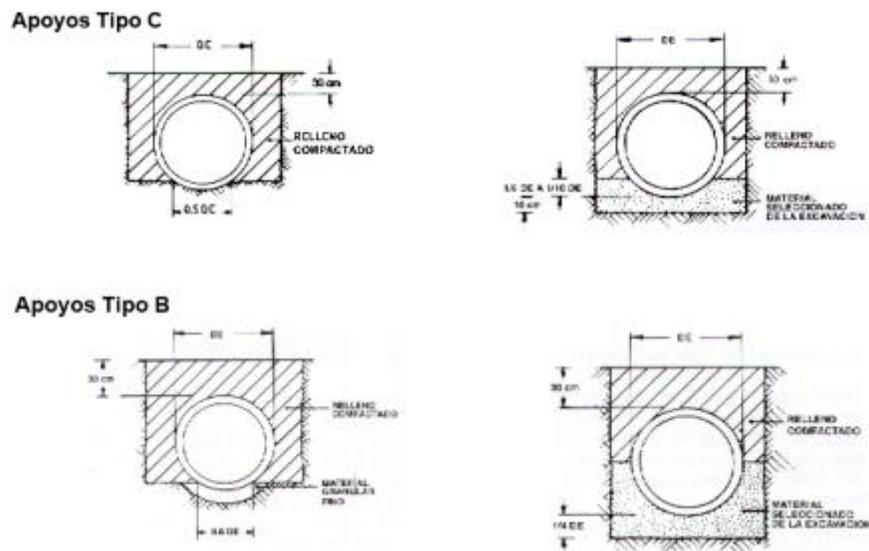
Cama de apoyo, apropiadas para tuberías de PVC
